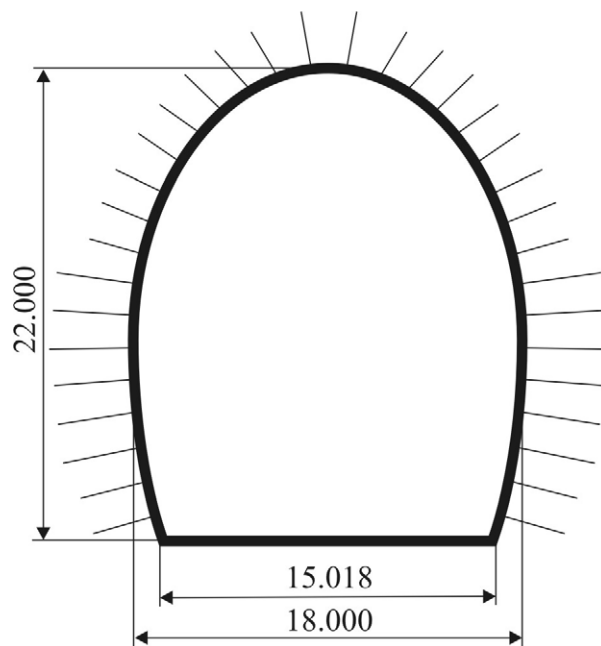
Поперечное сечение камеры нефтехранилища Куджи
